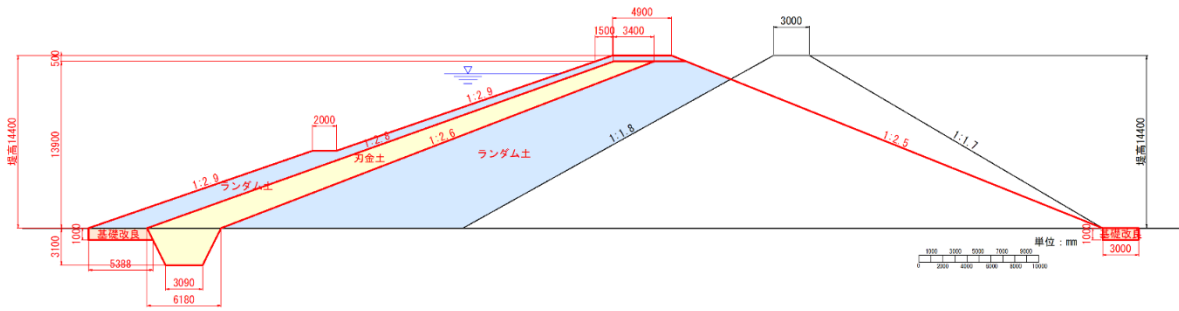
施工コスト算定用計画堤体断面（基礎改良工法）-3（H=14.4 m）
